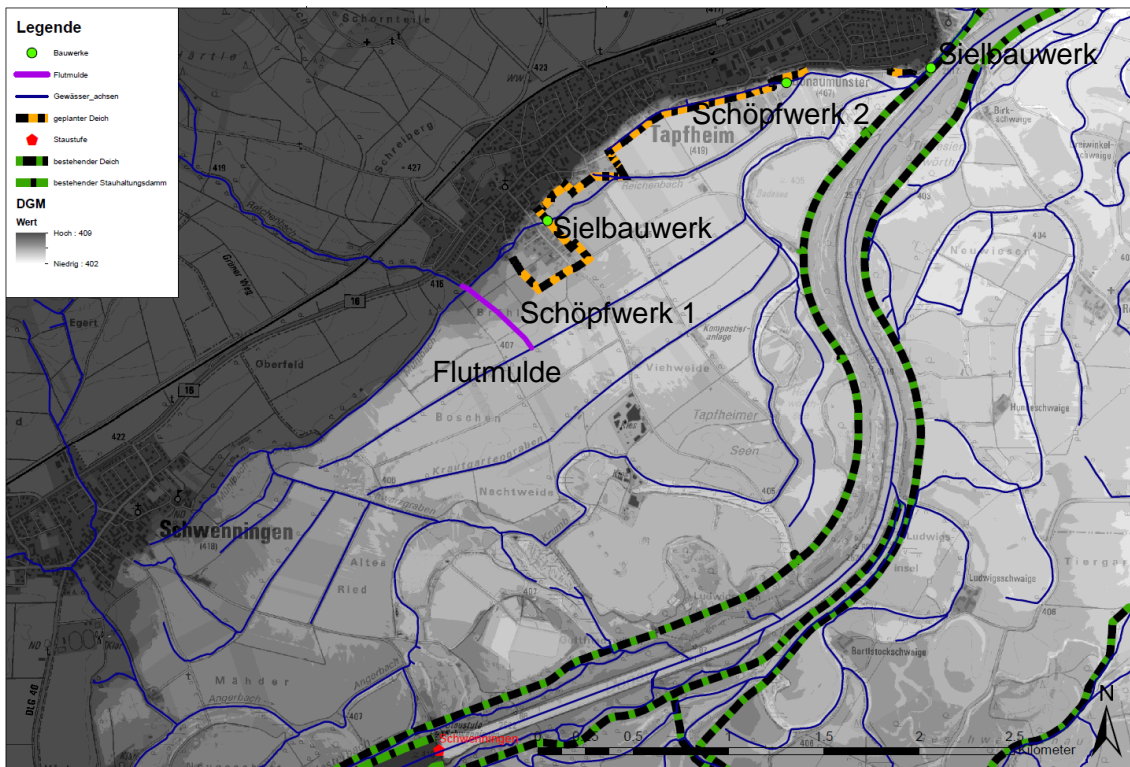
Lageplan Rückhalteraum Tapfheim, ROVar A
